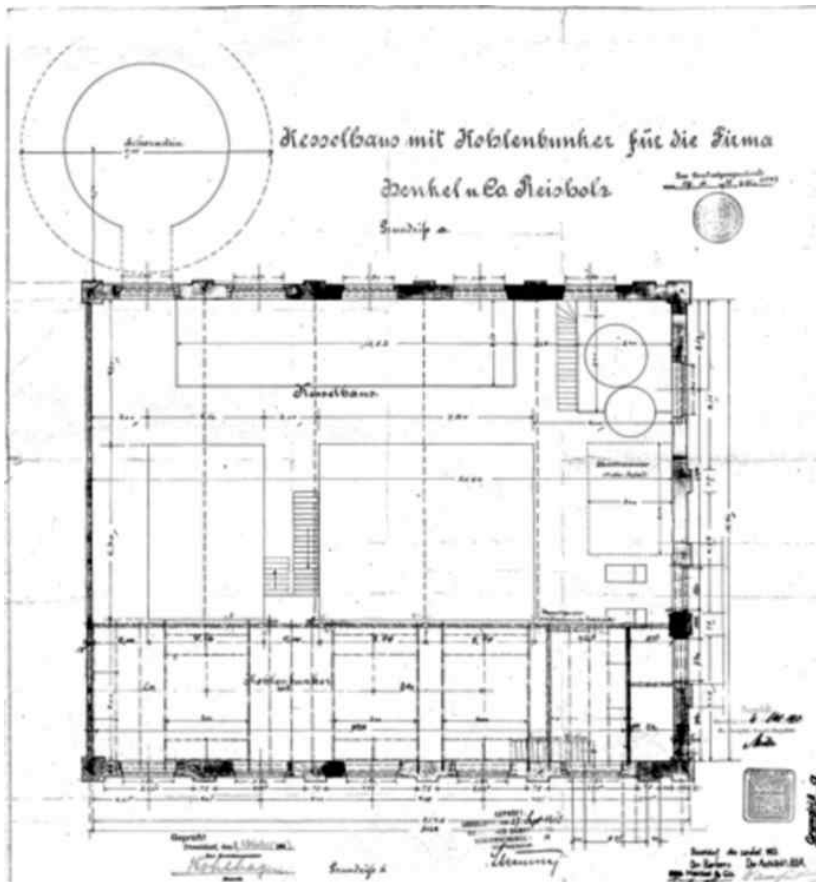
Neubau Kesselhaus Geb. F 02, 1913 - Architekt: Walter Furthmann
